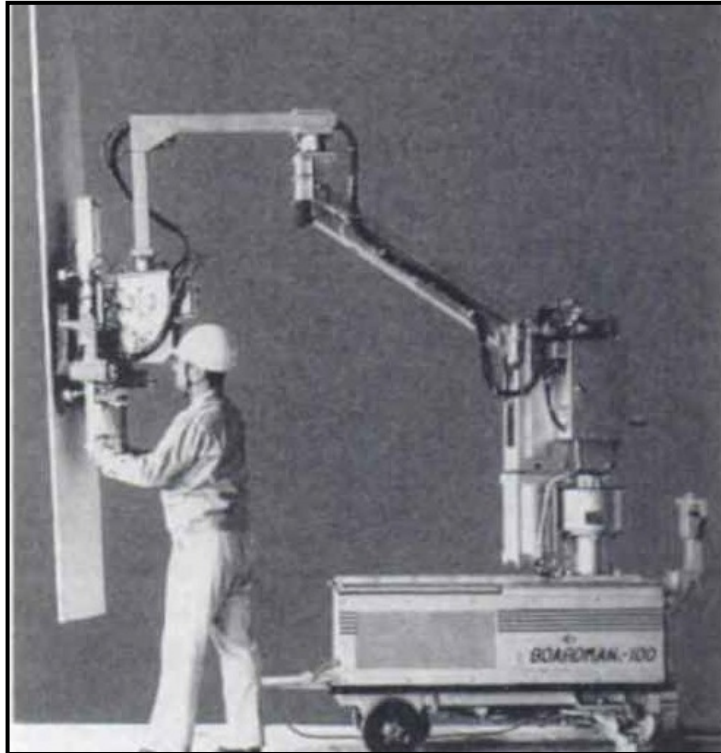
Robot para colocación de planchas Boarman -100. *Construction Robots. The search for new building technology in Japan.
